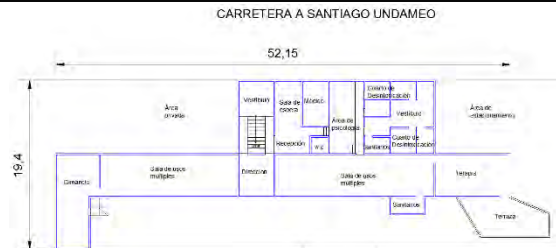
Croquis de planta baja de la Clínica Siete Ángeles, realizado por HGMB.
